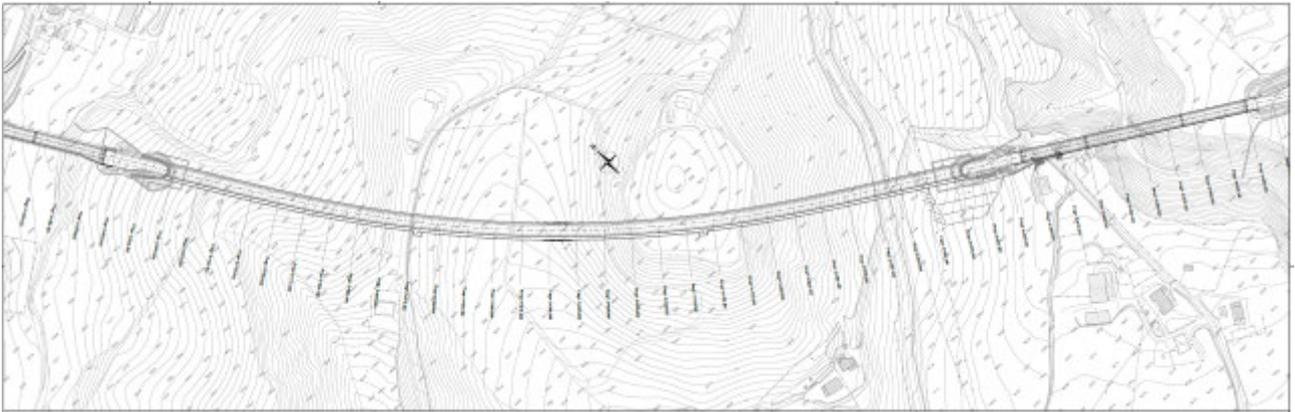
Stralcio planimetrico della galleria "Urbania II"
